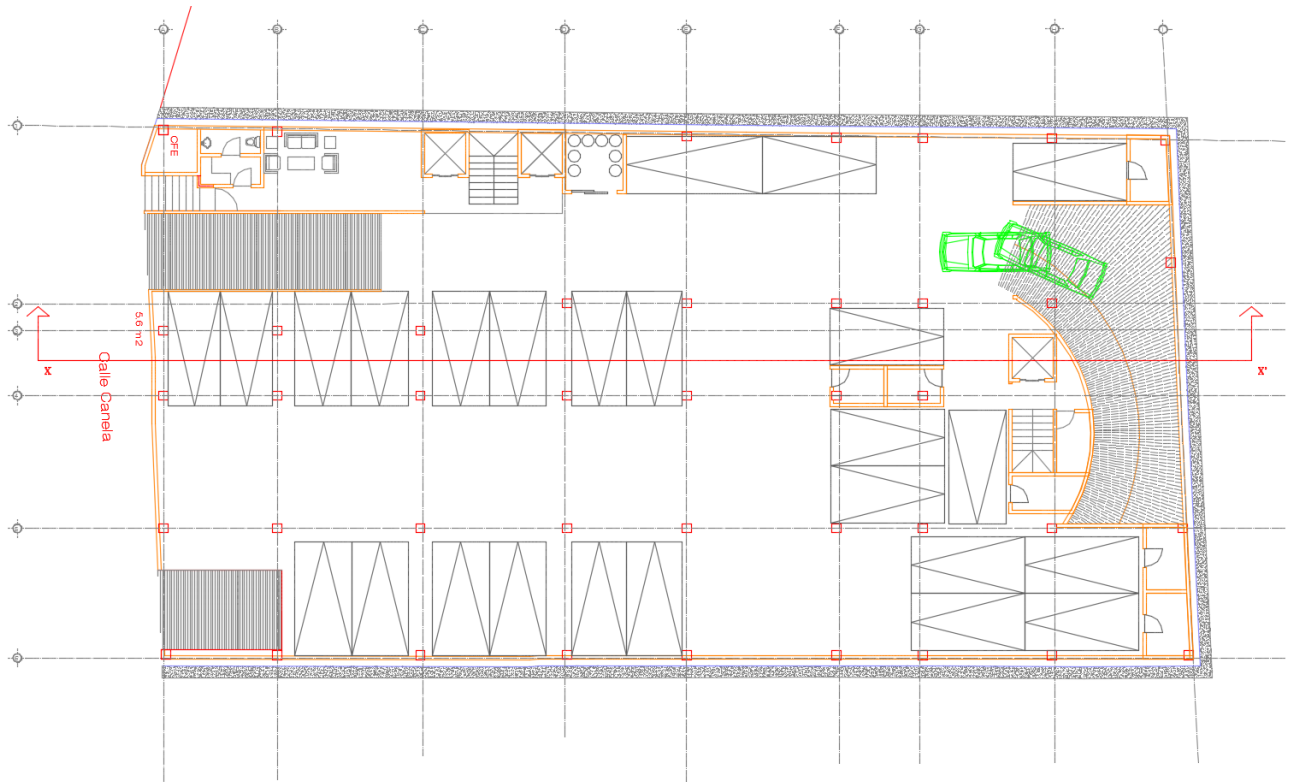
PLANTA ARQUITECTÓNICA SÓTANO 1
